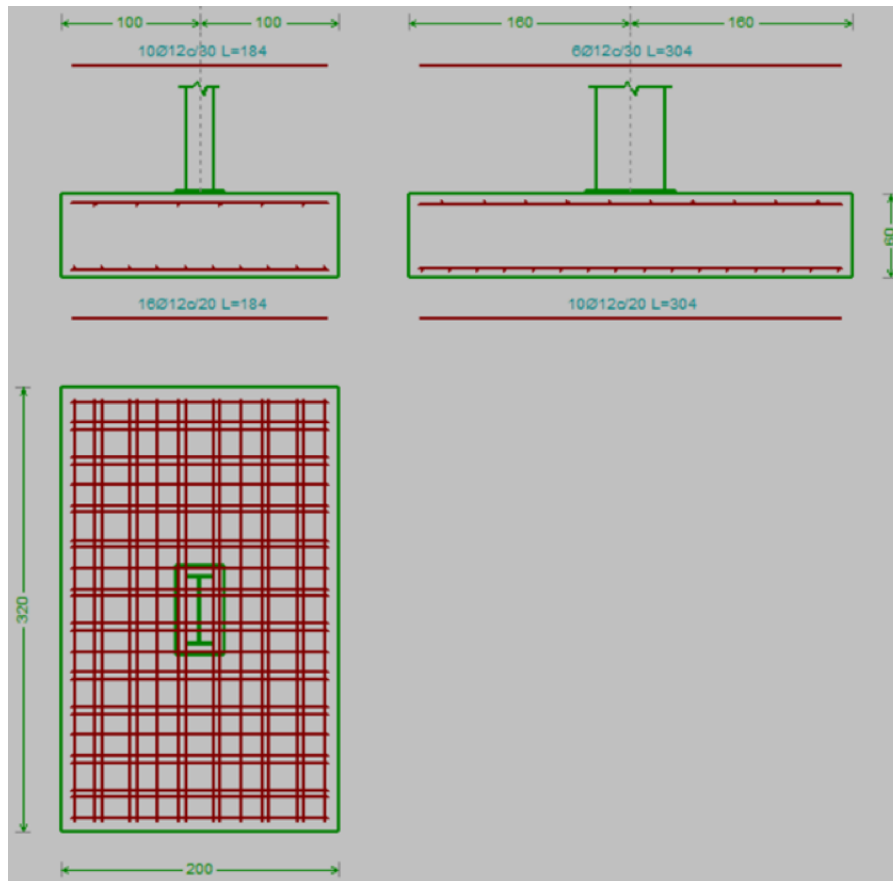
Planta, alzado y perfil de la zapata correspondiente al pilar esquina IPE 500
